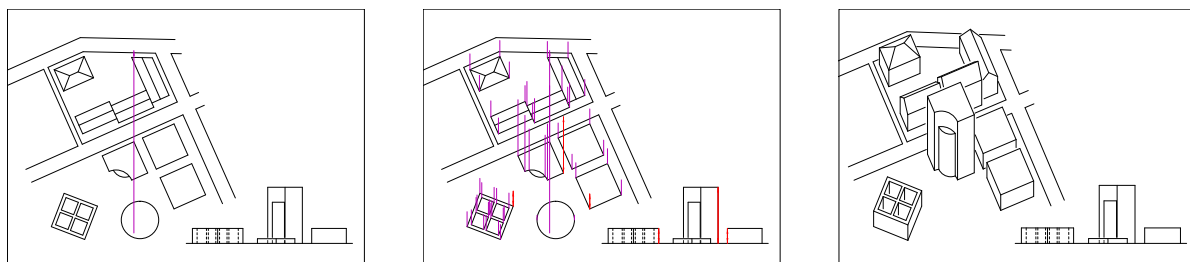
Konstruktion einer Grundrissaxonometrie
